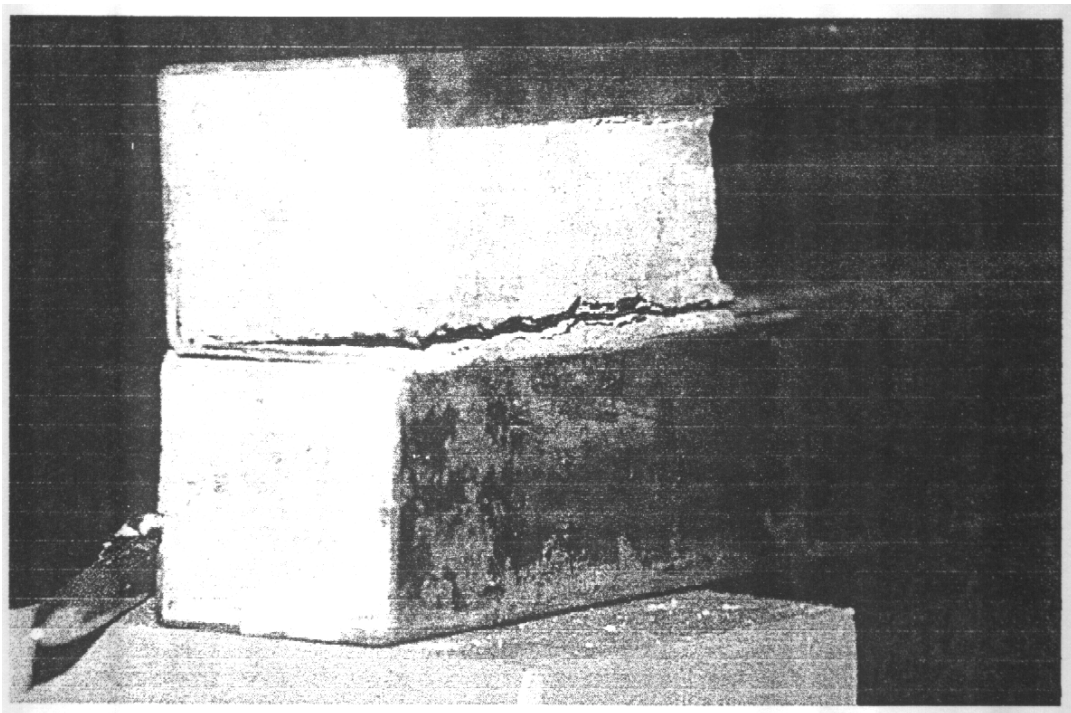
Distorção da seção do apoio do perfil M17AC.
